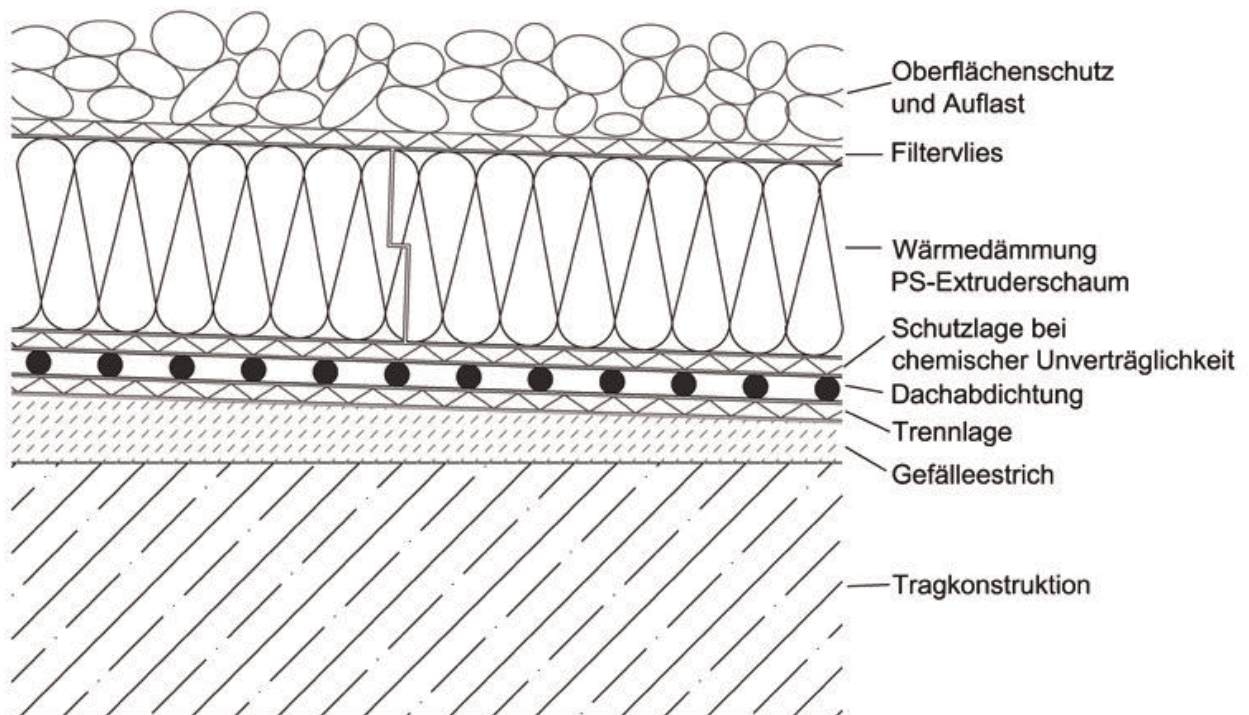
Konstruktionsart: Nicht belüftetes Dach als Umkehrdach, Abdichtung mit Kunststoff-/Elastomerbahnen, lose Verlegung mit Auflast
